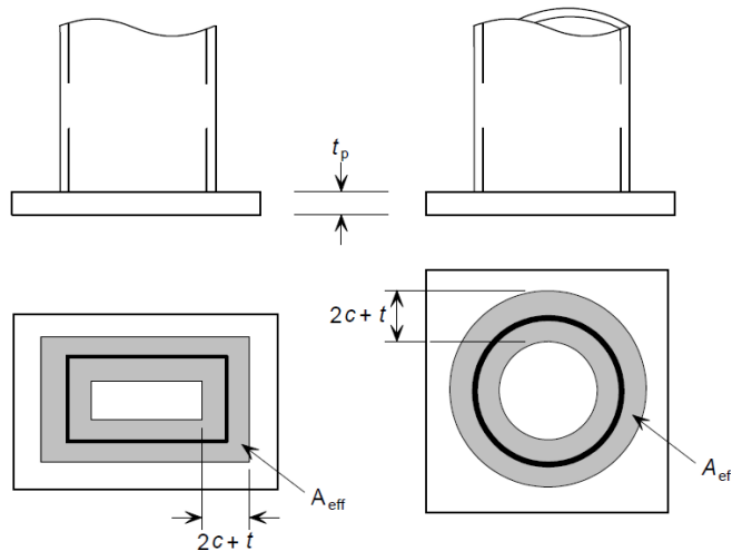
Largeur additionnelle pour les poteaux tubulaires
